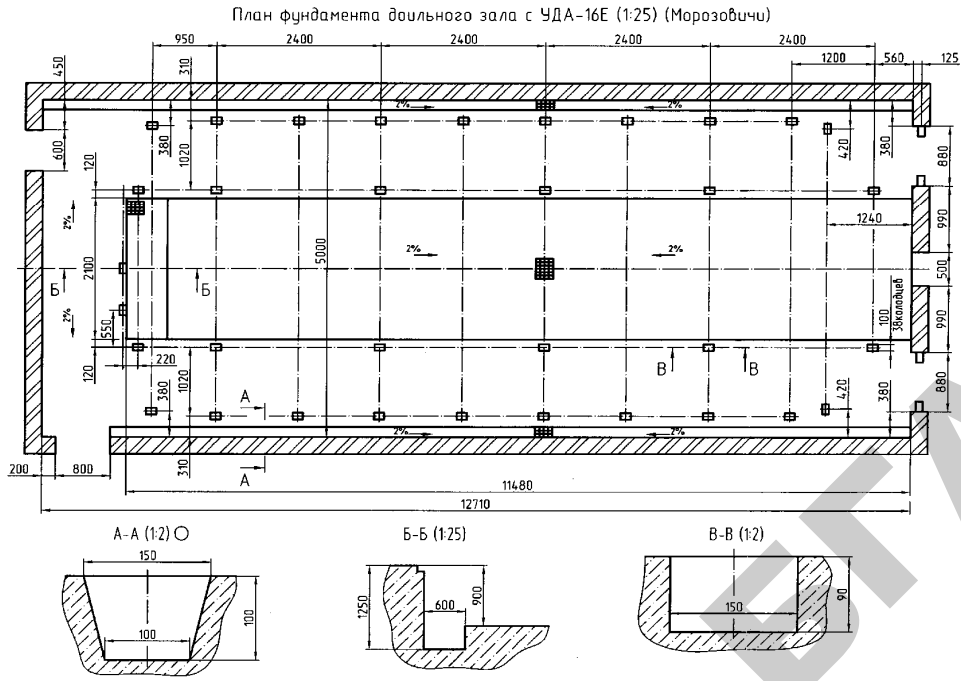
Планировка доильного зала с доильной установкой УДА-16Е
